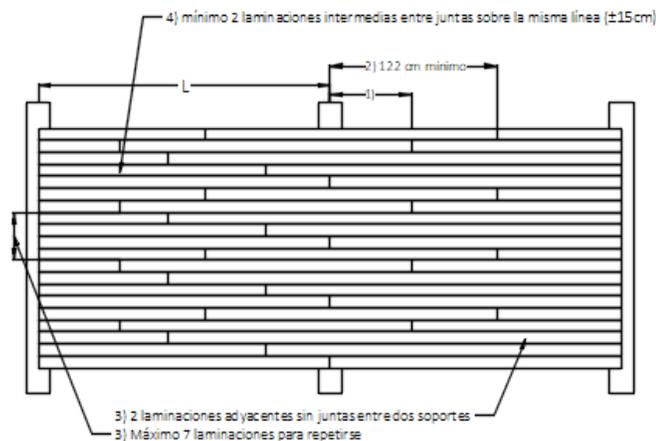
MLC tipo 3, laminaciones con juntas controladas en menos de 4 apoyos
